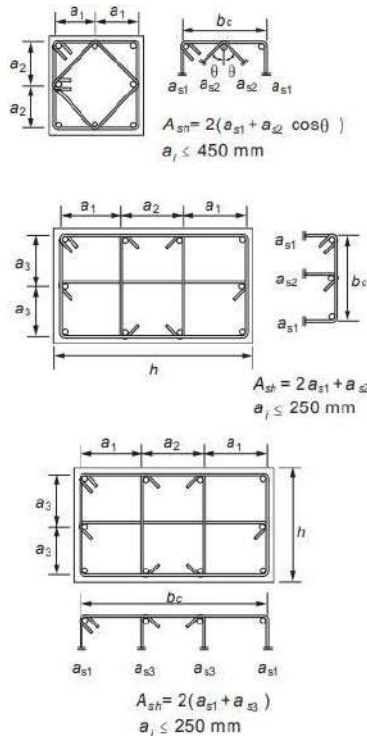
Determinación de la cuantía de refuerzo transversal en miembros a flexocompresión
